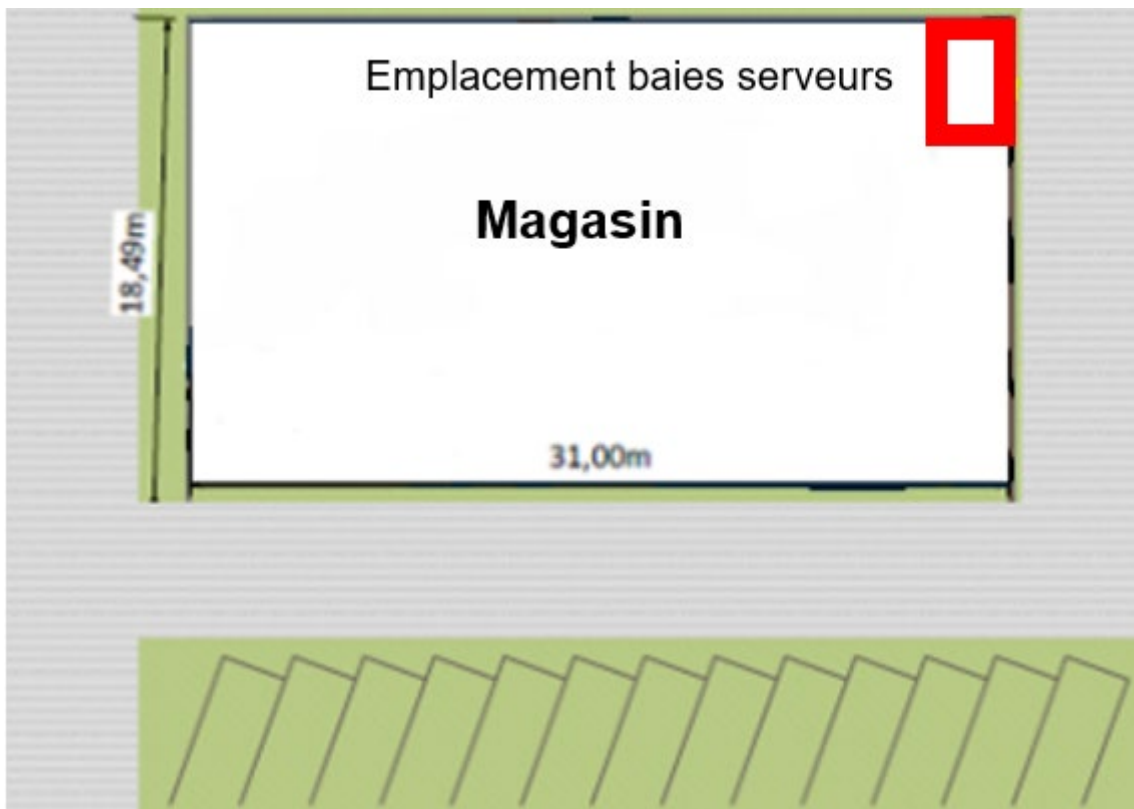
Plan d'implantation du de la baie serveur à Mâcon
